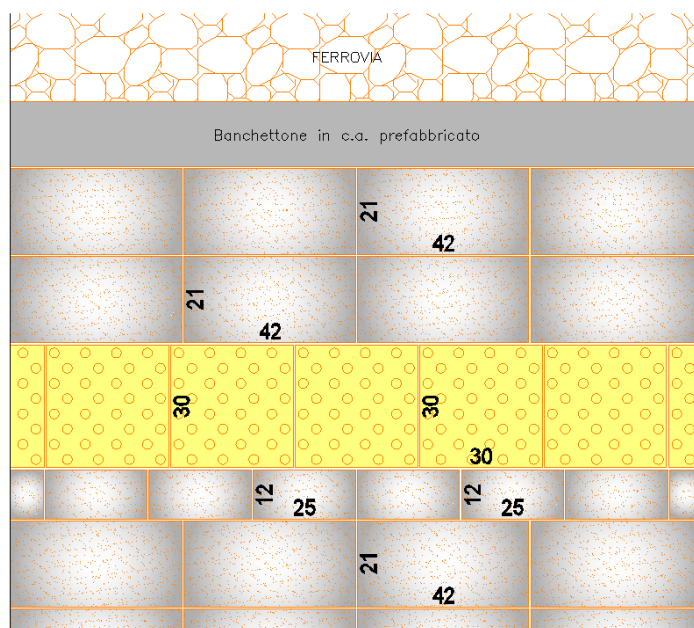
Particolari schemi di posa in opera dei masselli autobloccanti di pavimentazione delle banchine
